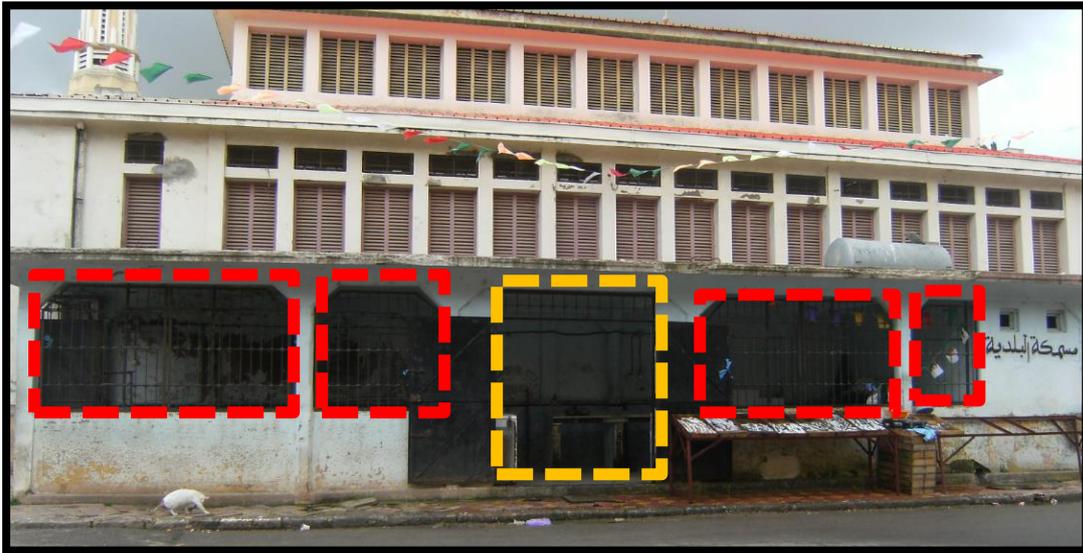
représente l'intérieur et l'extérieur de la poissonnerie
